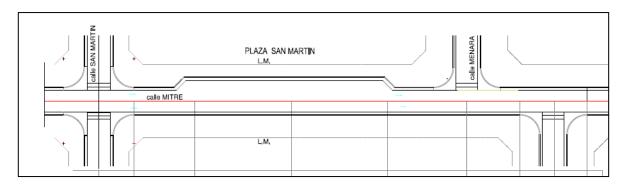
Planta tramo calle Mitre entre San Martín y Menara (s/proyecto de CAFESG)
